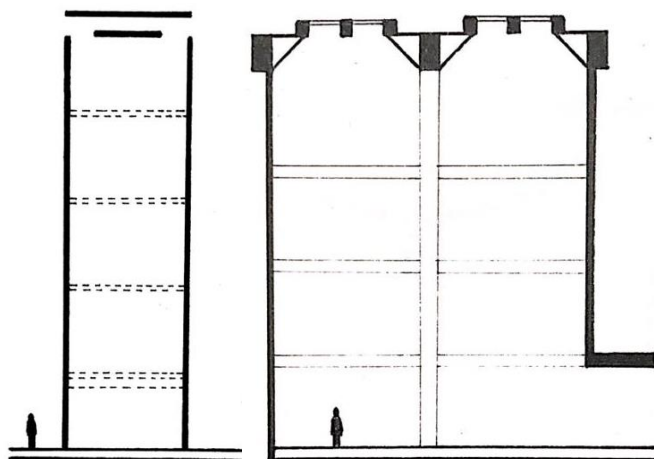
Corte centro de arte británico de Yale, New Haven, Connecticut, Estados Unidos
